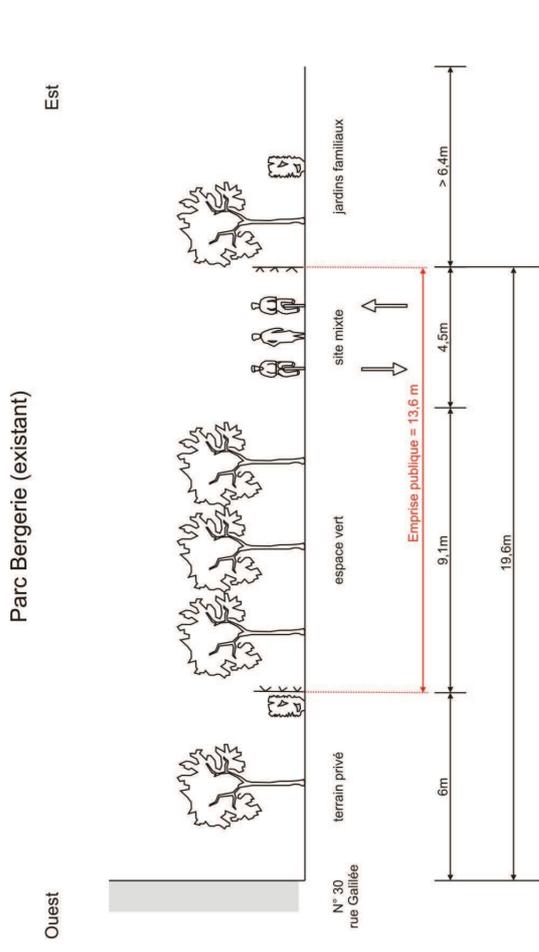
Situation existante coupe 8 sur le parc de la Bergerie
